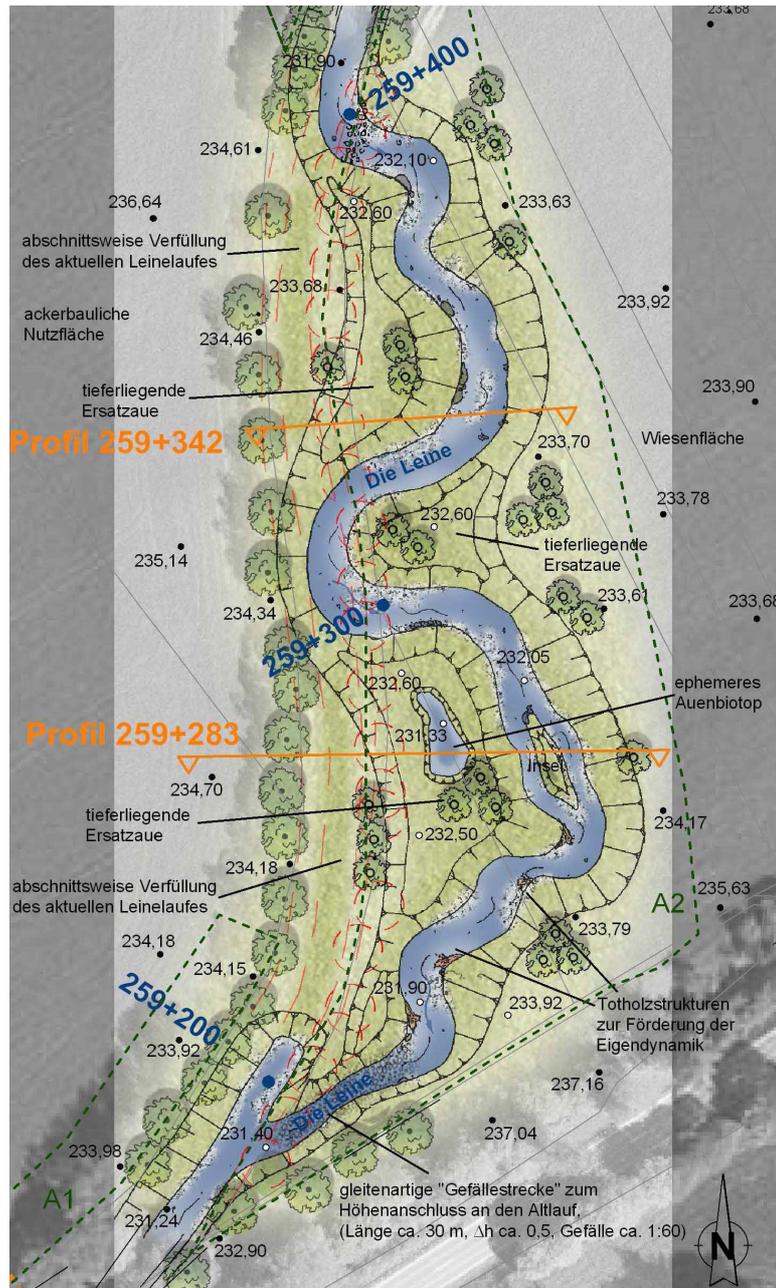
Planung im unteren Bereich des Planungsabschnittes 12 (vgl. Plan B-3.12)
